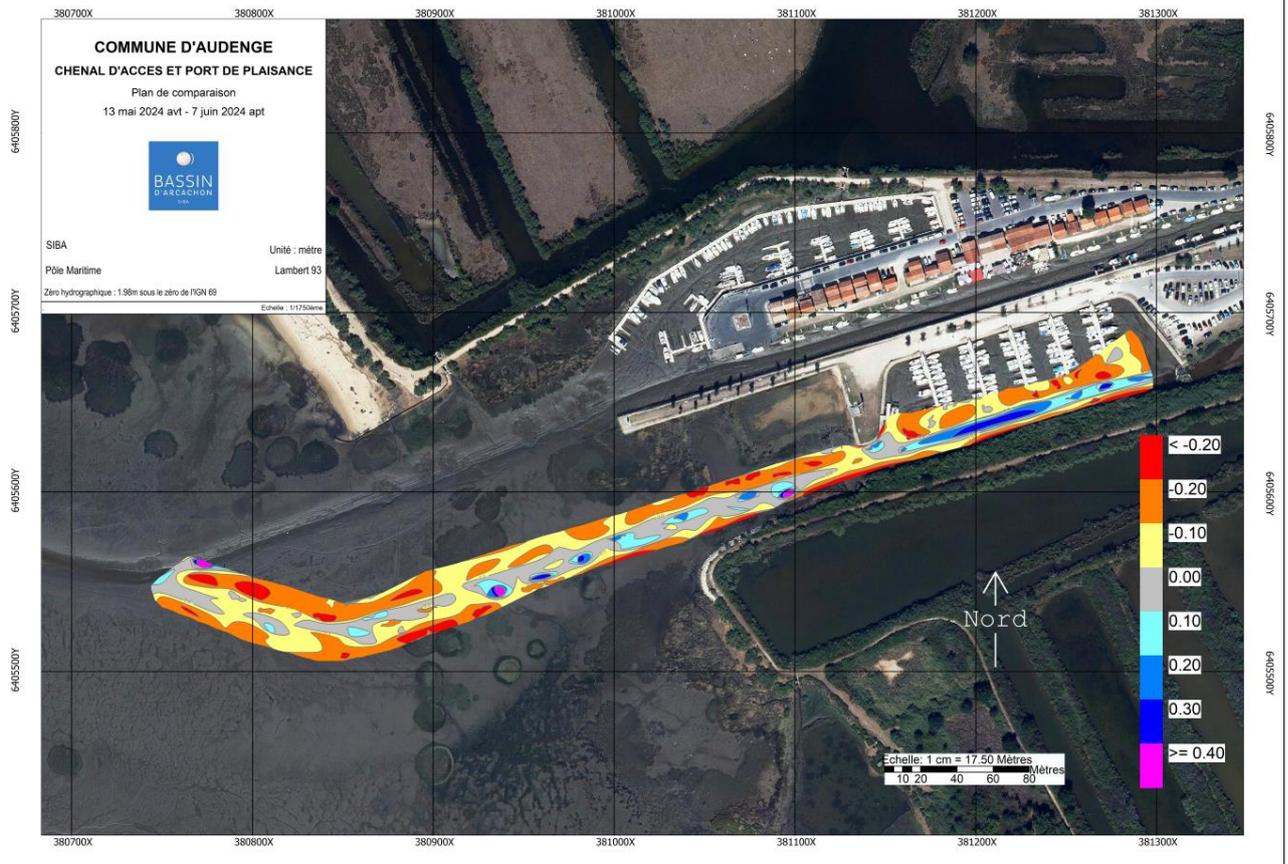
Plan de comparaison entre les levés avant et après travaux
